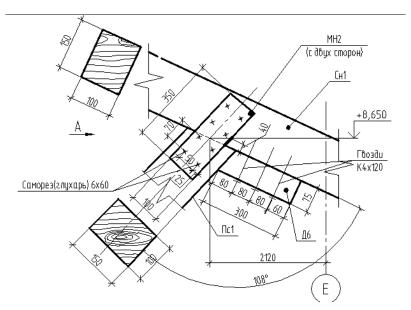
Узел крепления подкоса к стропильной ноге
